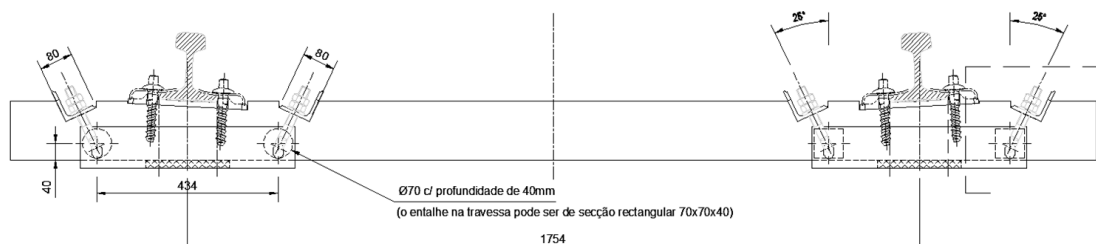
Sistema de fixação da travessa à estrutura, em reta
